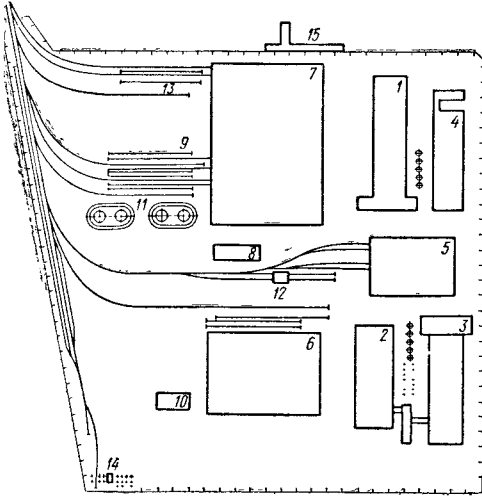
Схема генплана завода стального и чугунного литья и сварных металлоконструкций («Ленгипротяжмаш»):
